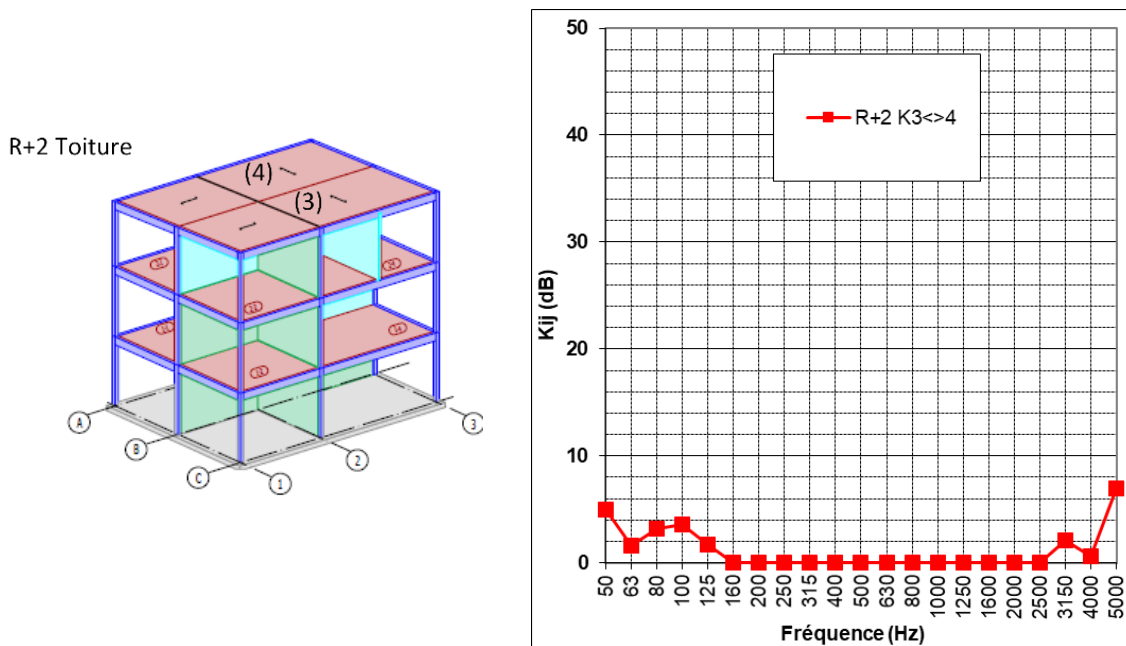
Jonction filante en toiture avec 2 panneaux CLT sur poutre.
